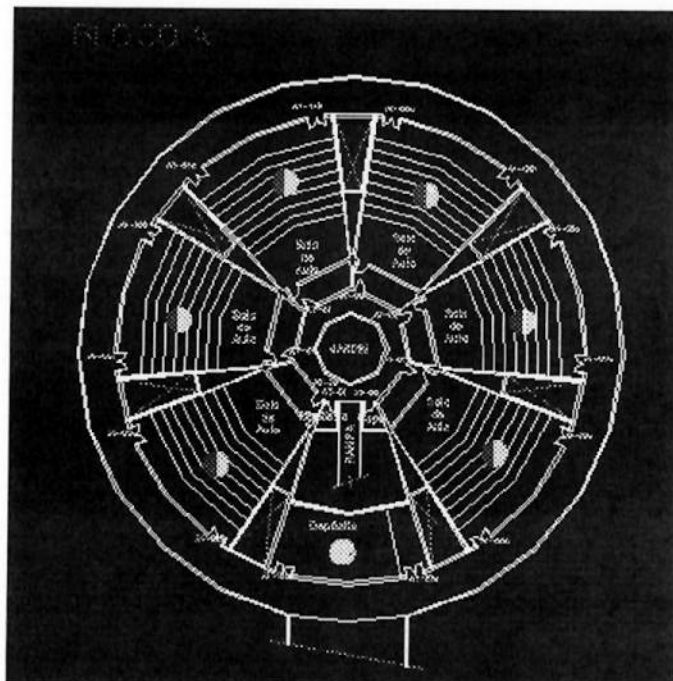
Exemplo de Planta Utilizada: "Cirquinho"
